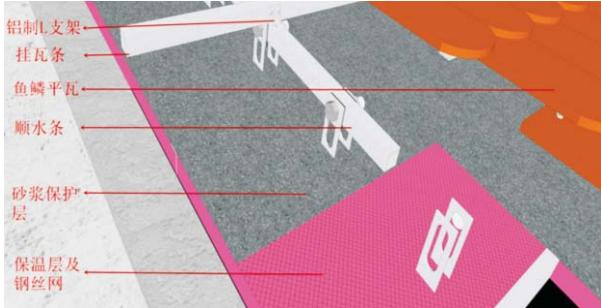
金属骨架干挂瓦屋面屋面层施工示意图
